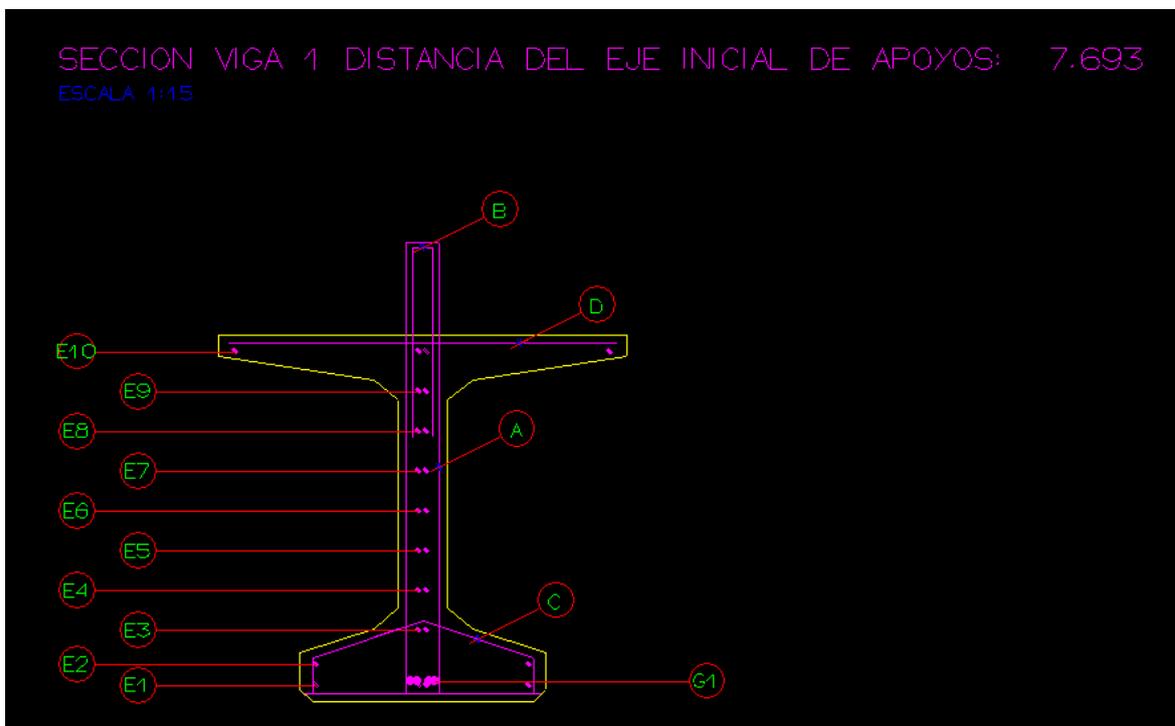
Figura *Vigas. Sección transversal*.
